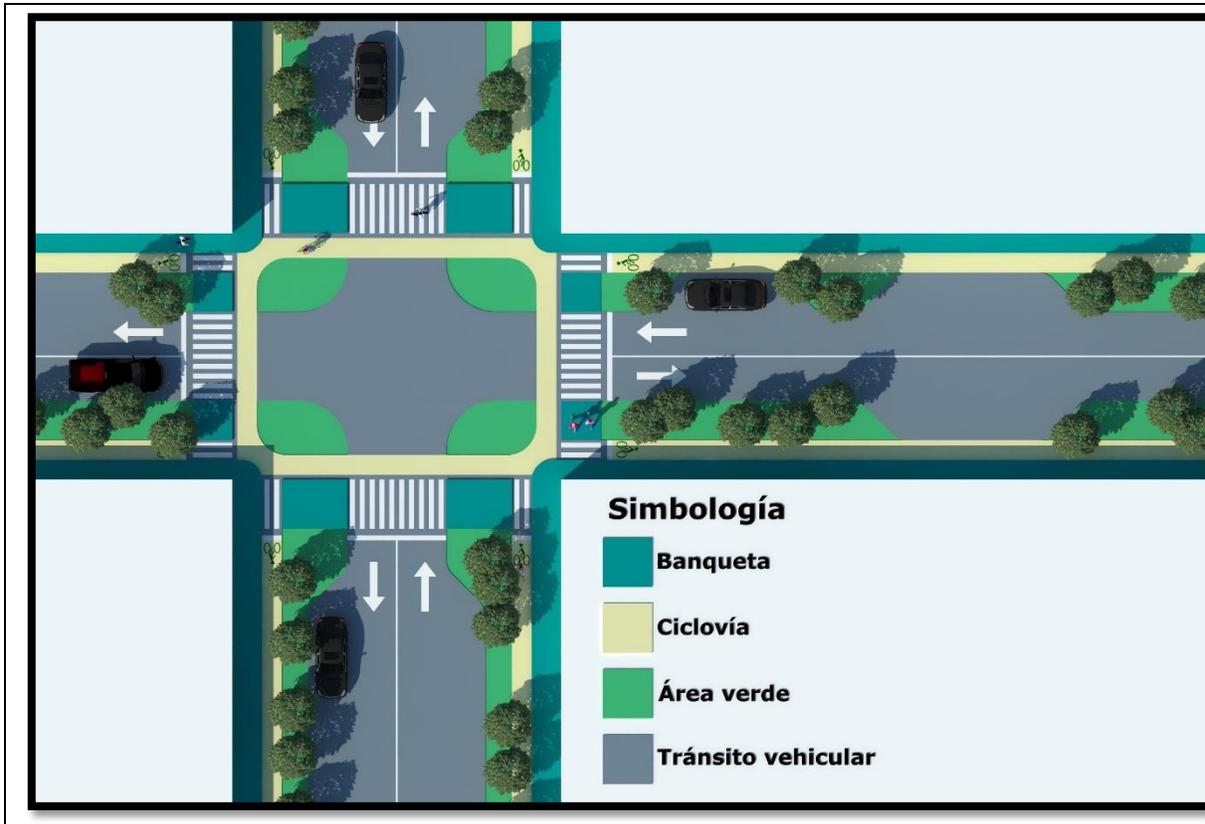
Planta prototipo 2. Diseño de vialidad que incluye una intersección con la calle Emiliano Zapata. Fuente: Elaboración propia
